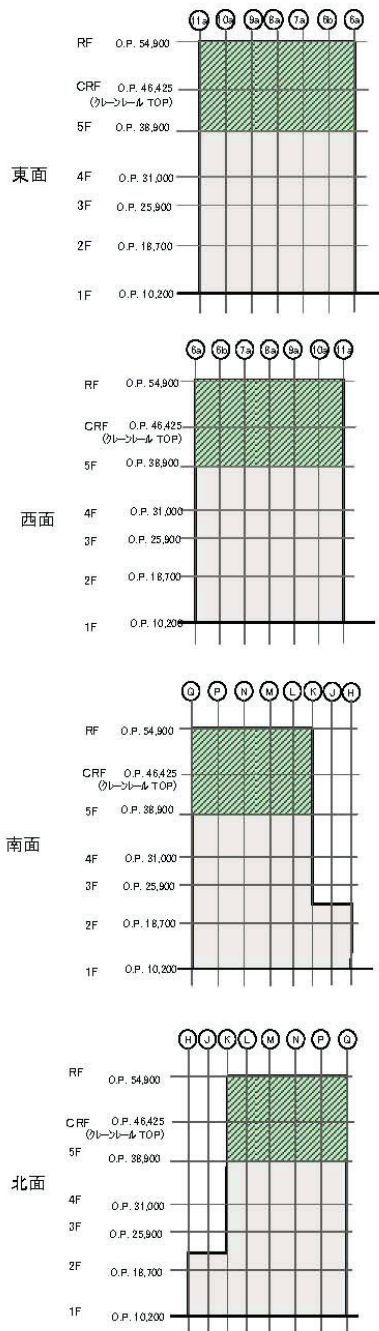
1号機原子炉建屋の損傷状況（立面図）
